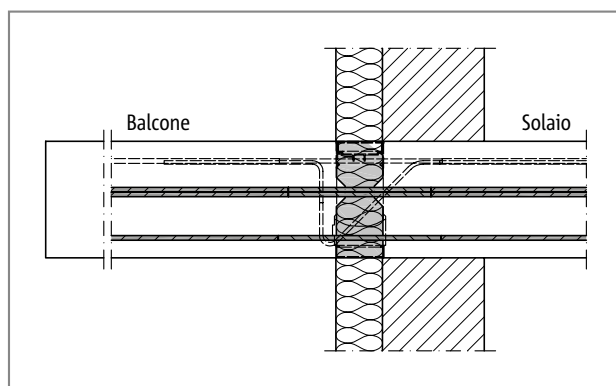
Schöck Isokorb® tipo EQ: balcone a sbalzo
